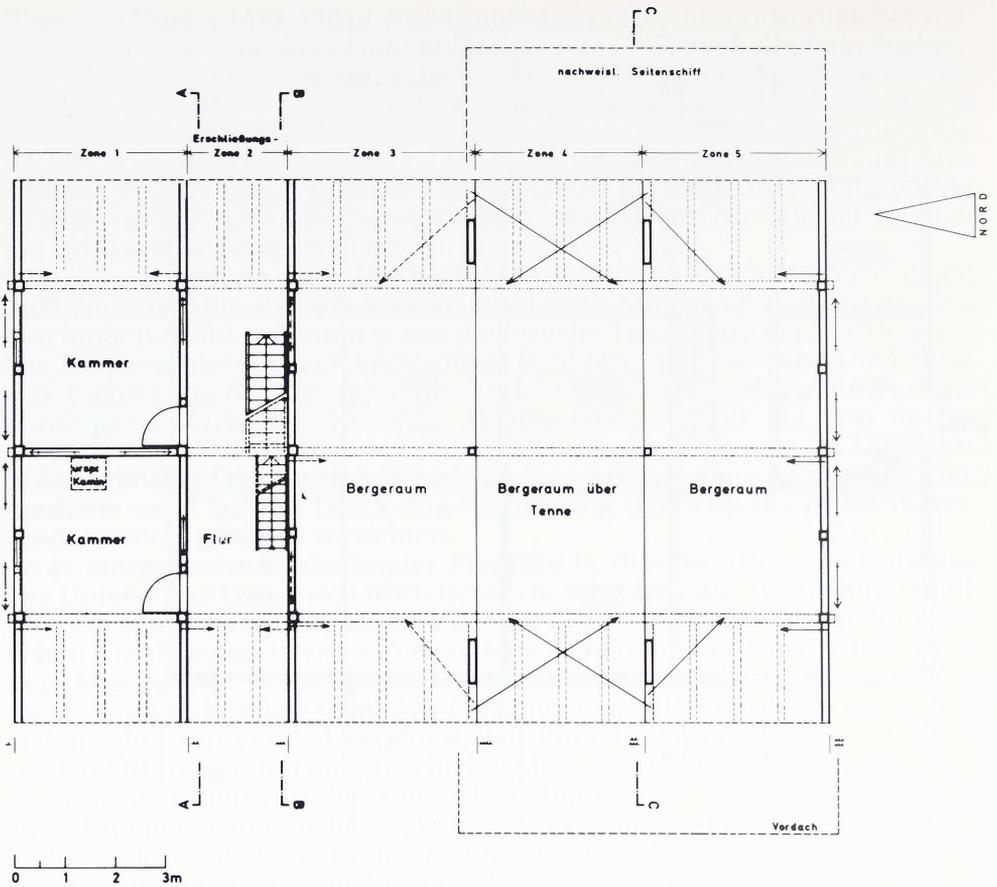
Metzingen, Gustav-Werner-Straße 21, Grundriß erstes Dachgeschoß.
